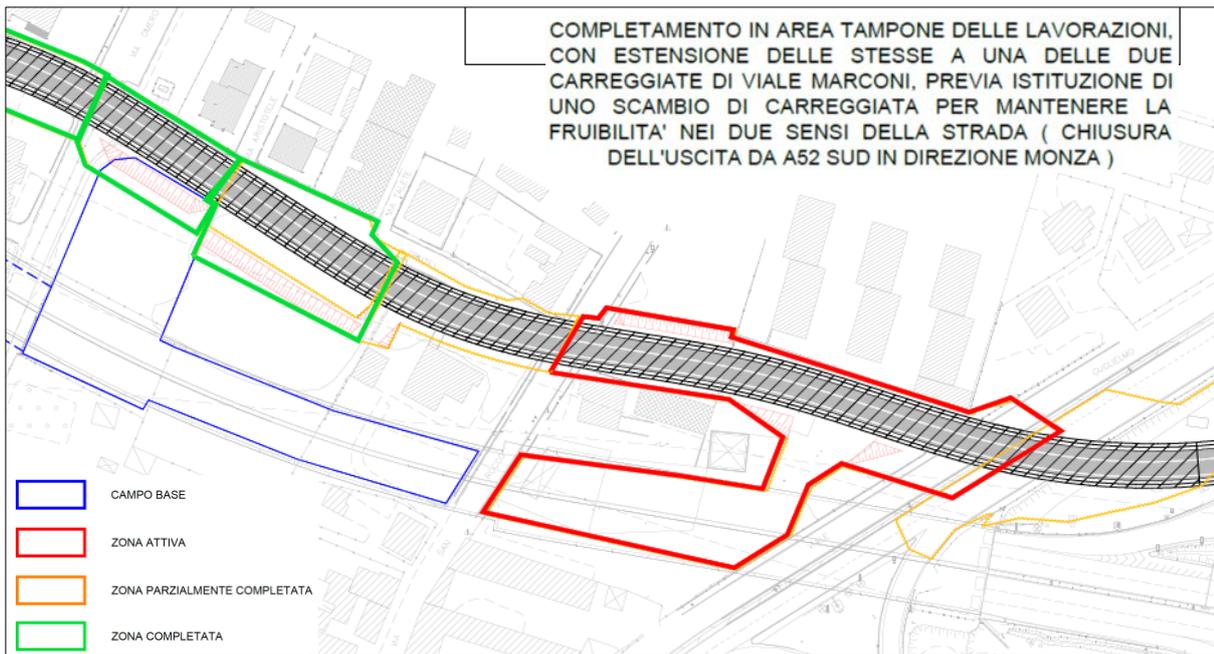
Fasi realizzazione copertura galleria del Piano di Sicurezza di progetto illustrativo della fase E di scavo della galleria.
